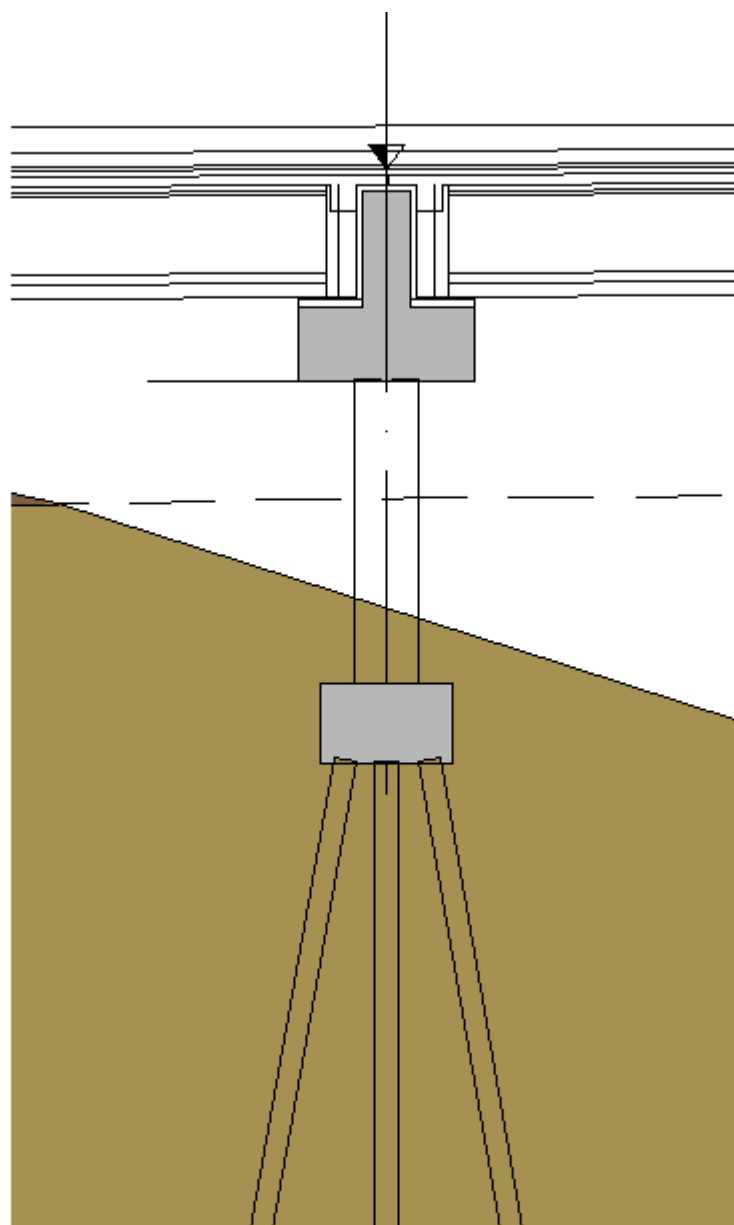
Elevação típica de um pilar com fundação por tubulões
